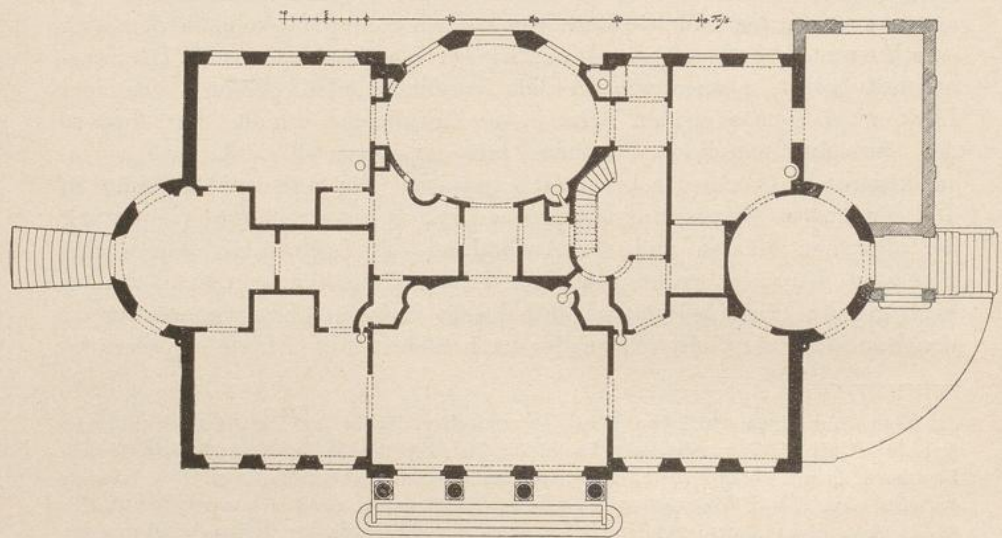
v. Erlangersches Gartenhaus; Grundriss.
